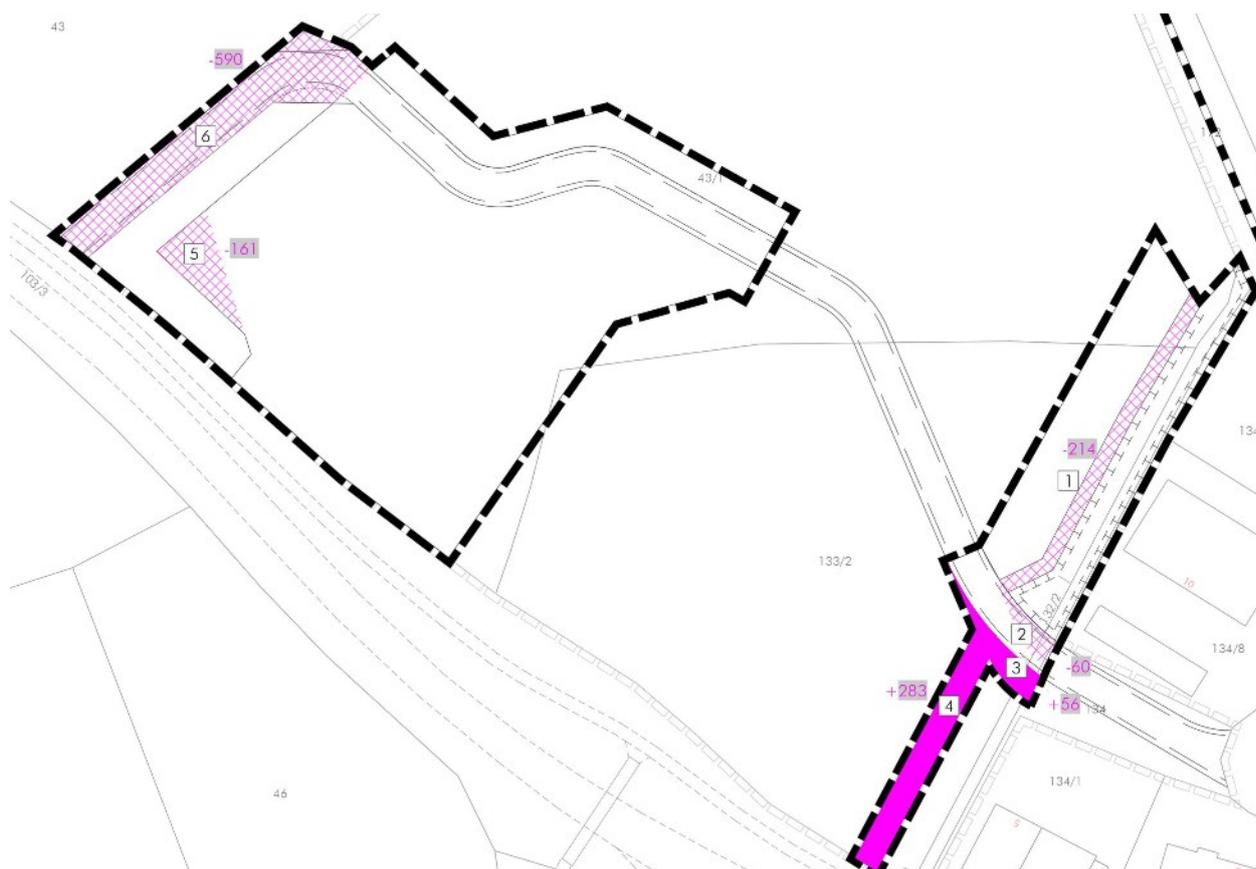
Lageübersicht der Flächen mit Änderungen beim Eingriff (Pink).
